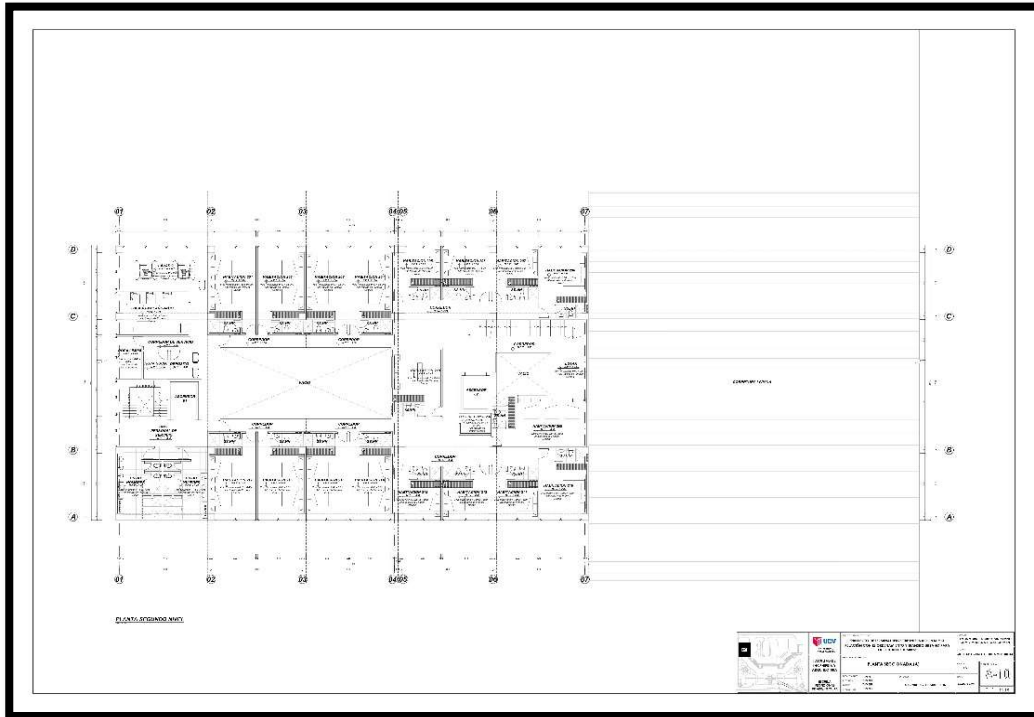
Plano Planta sector (A) Segundo Nivel Fuente: Elaboración Propia.
